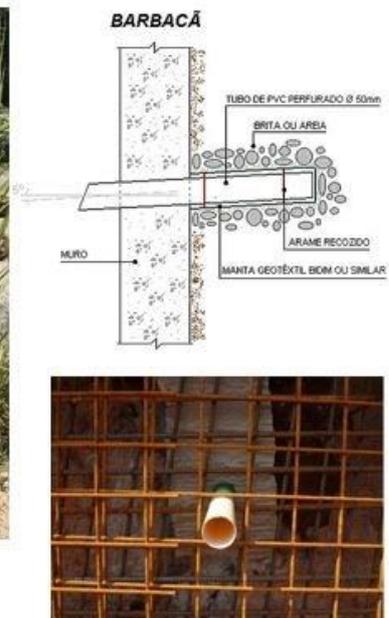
Detalhe do Sistema de Drenagem em Cortina Atirantada. Fonte: Autor.
